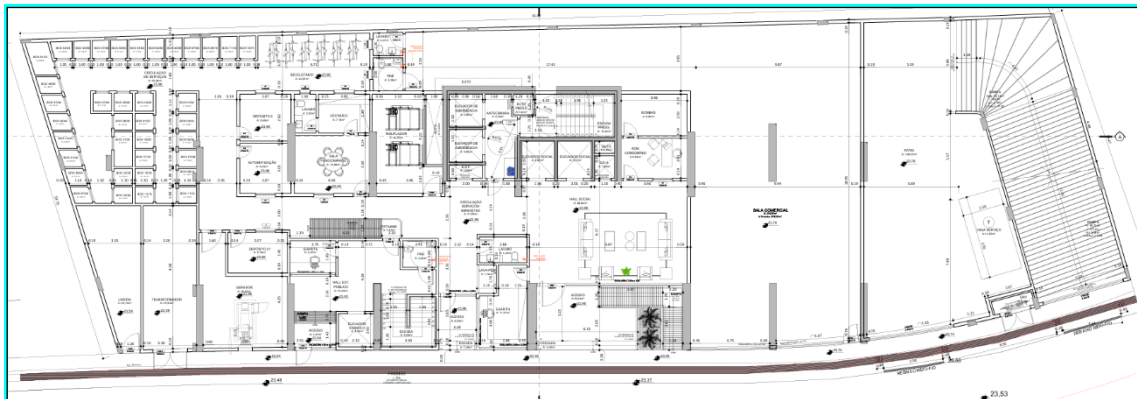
Pavimento térreo do empreendimento. Fonte: Projeto Arquitetônico, 2026.
